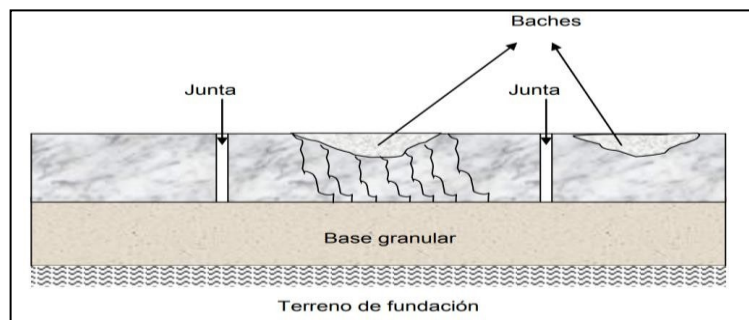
Falla por rotura o bacheo de Pavimento Rígido
